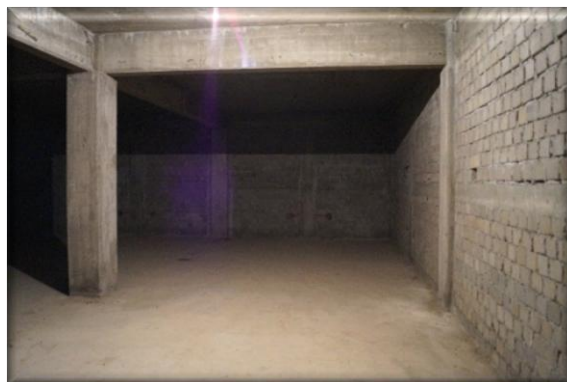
Vistas del sótano en donde se observan las columnas y traveses de concreto armado y los muros de tabicón.
